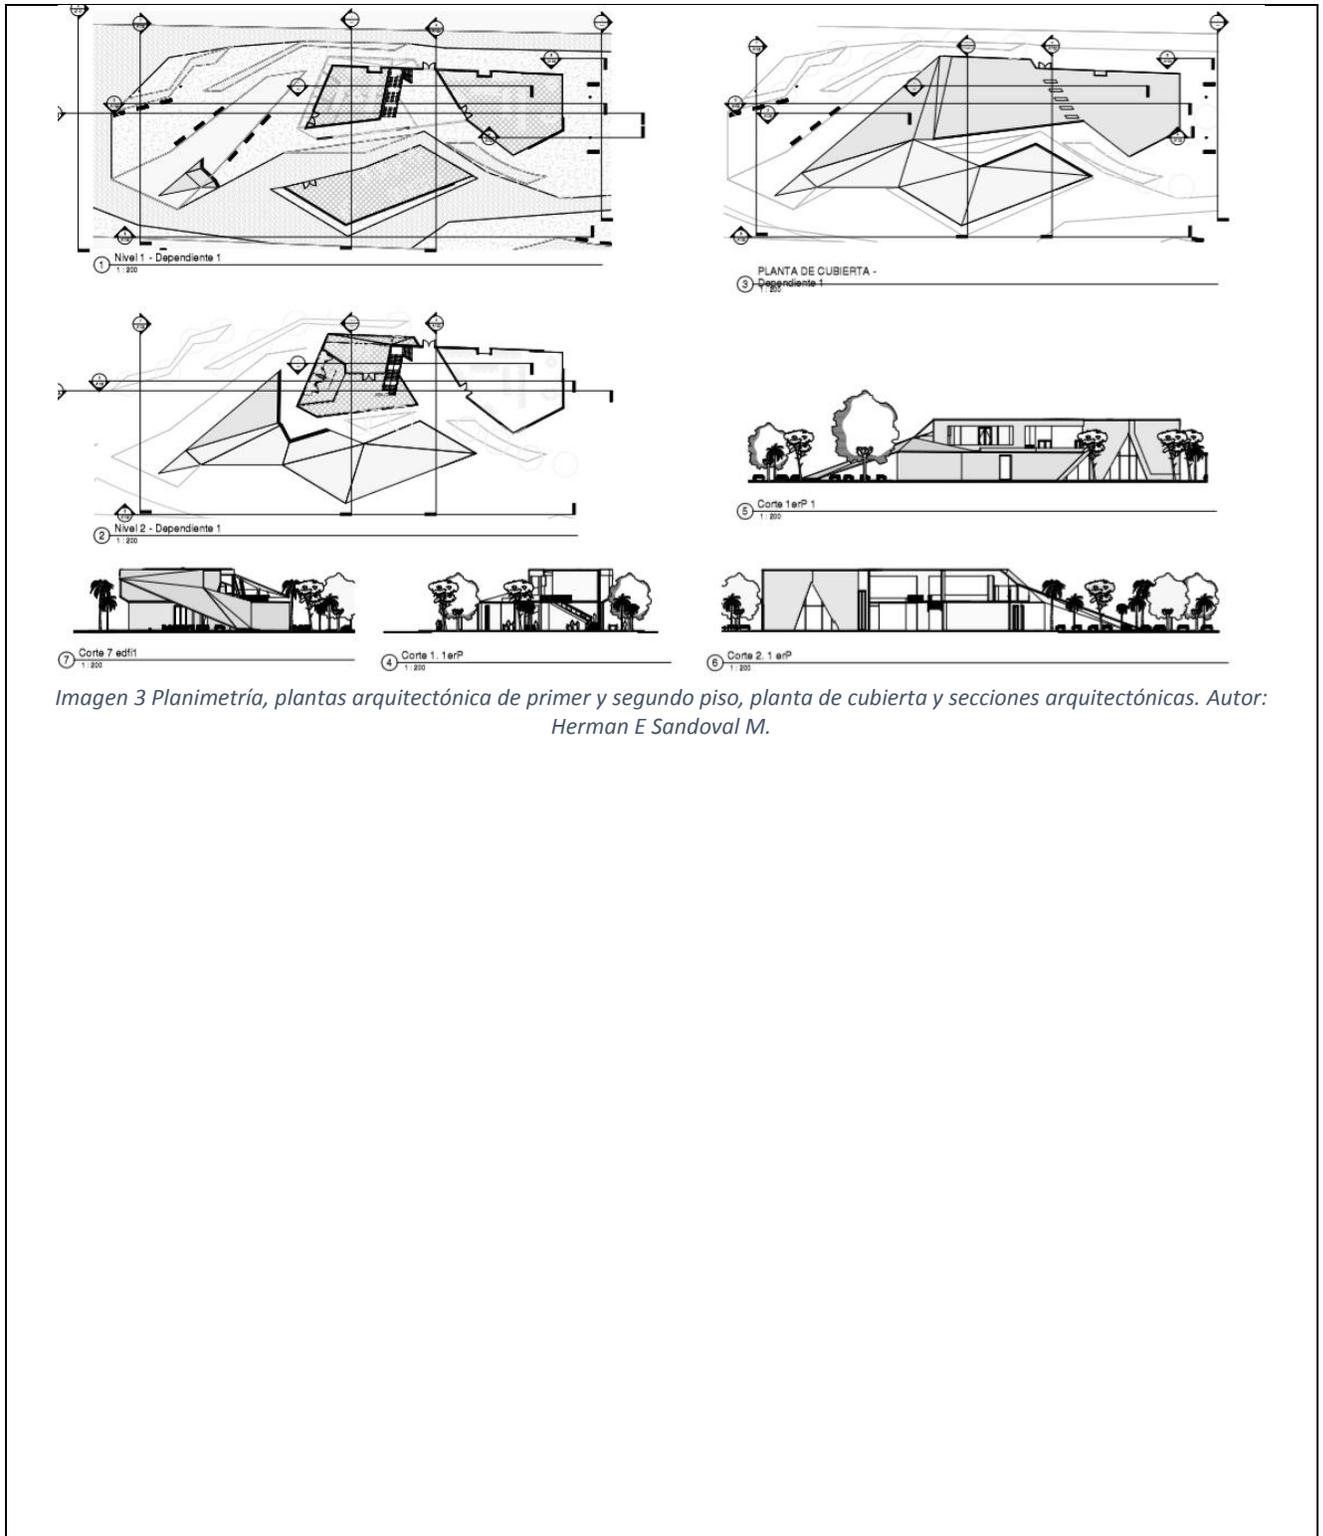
Planimetría, plantas arquitectónica de primer y segundo piso, planta de cubierta y secciones arquitectónicas. Autor: Herman E Sandoval M.
